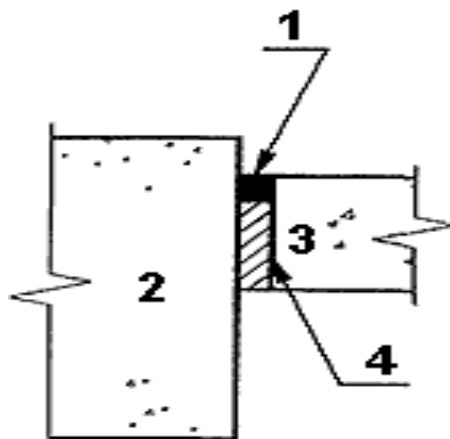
Конструкция изолирующего шва между фундаментом для установки оборудования или стеной и плитой пола
